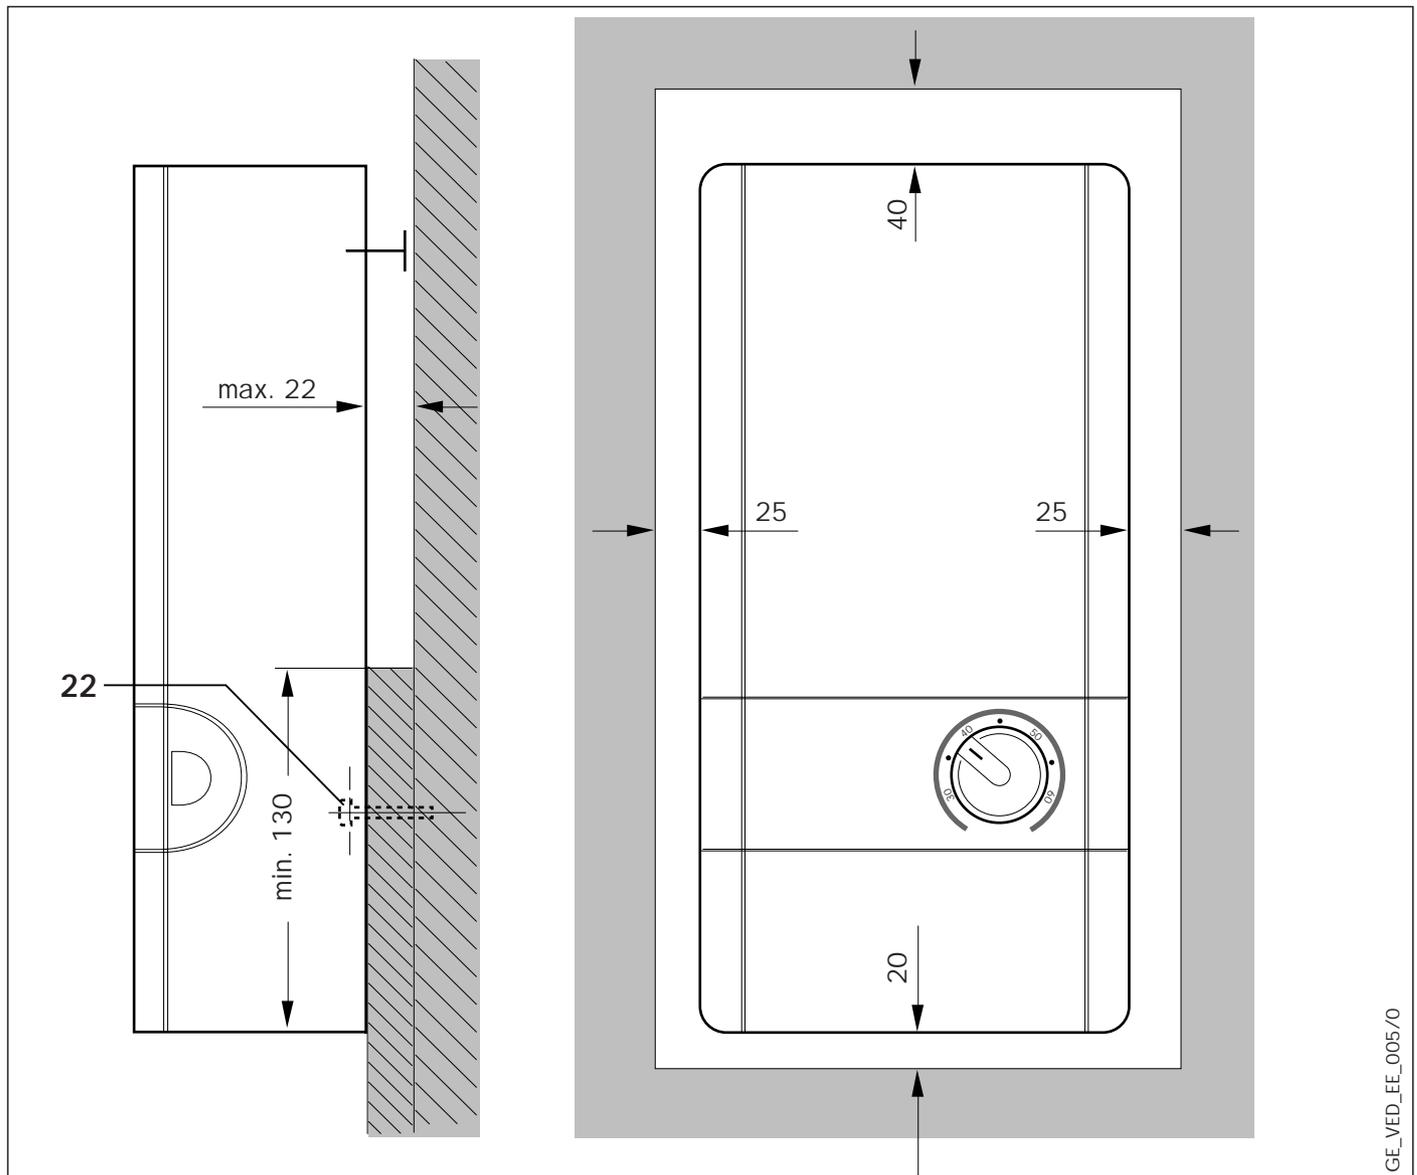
Installationswand mit Mindestabständen in mm zur Umbauung
